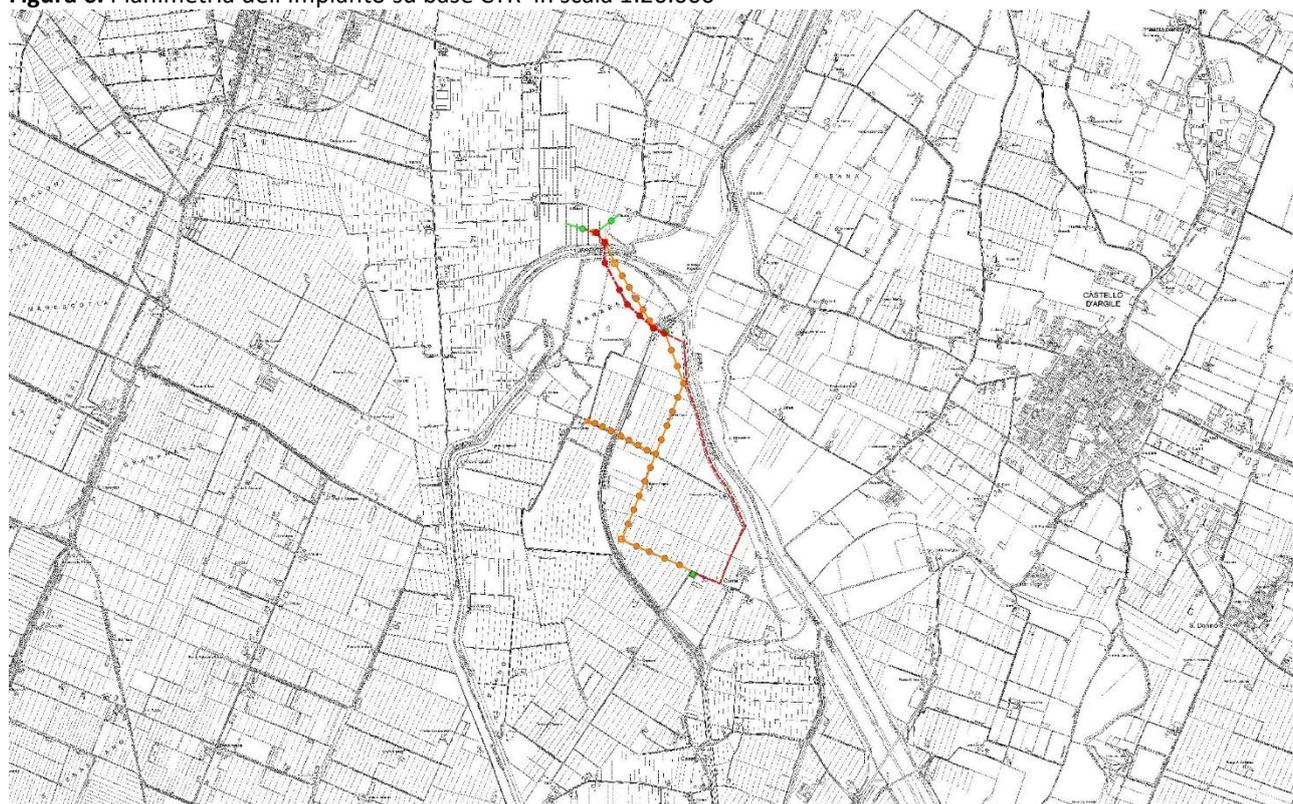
Planimetria dell'impianto su base CTR in scala 1:10.000
